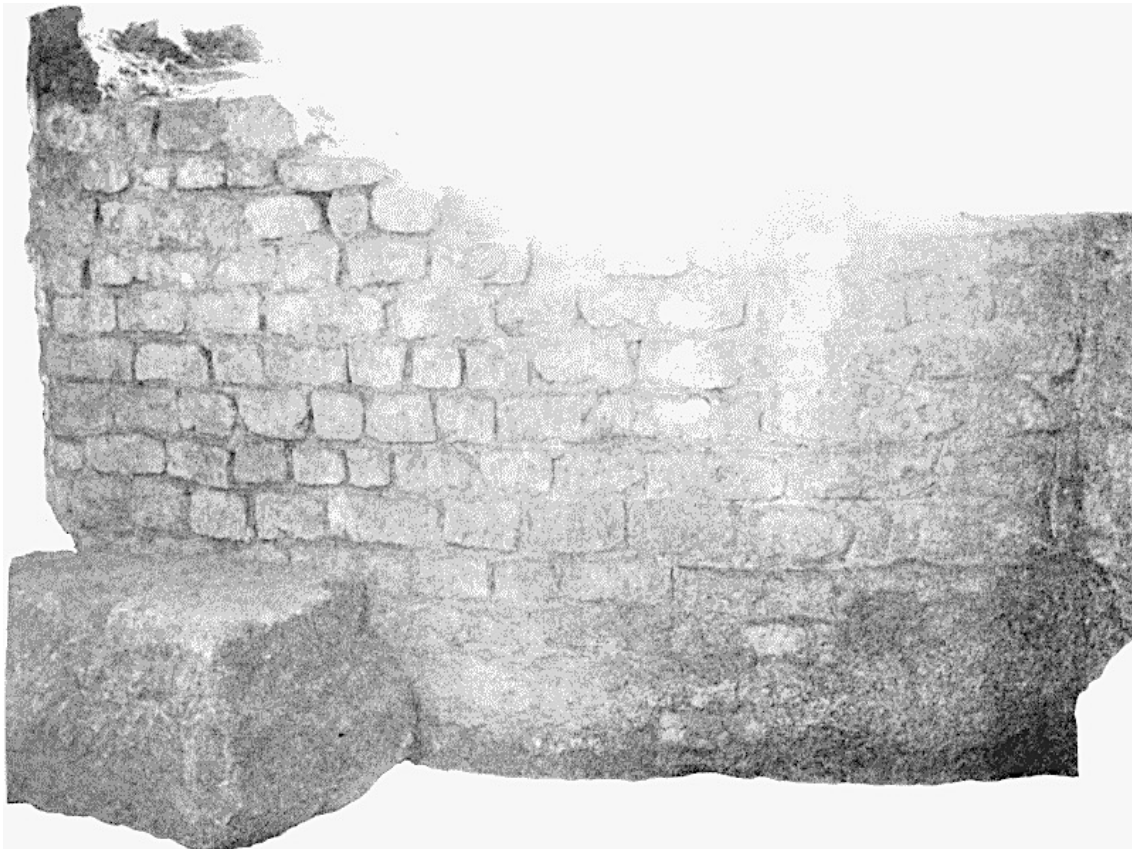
Albañilería de Muro alrededor del N.E. Ábside del Gran Baño, cara exterior.
